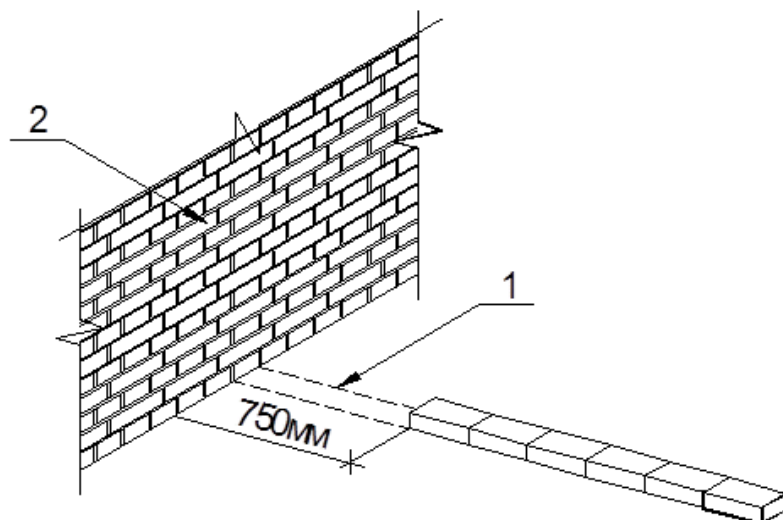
Раскладка кирпича перегородок. 1 – расстояние от стены до кирпича при раскладке, 2 – стена.
